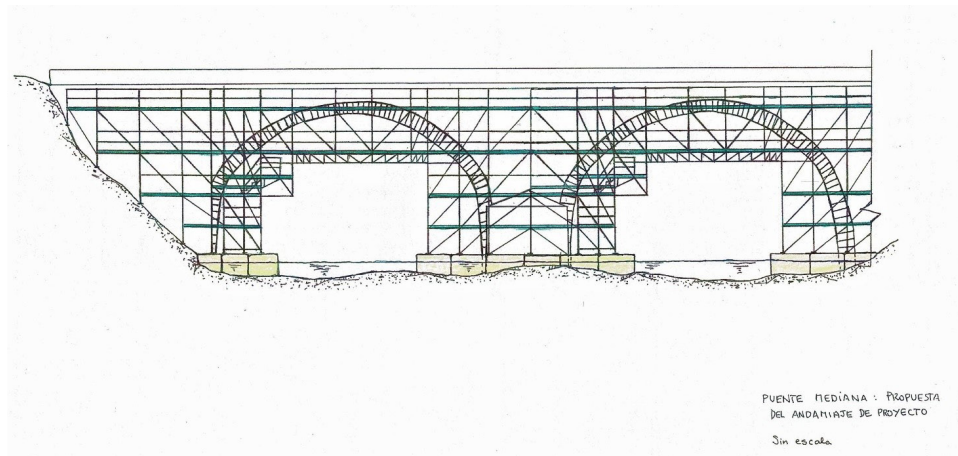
Propuesta de andamiaje de los alzados de un puente genérico
